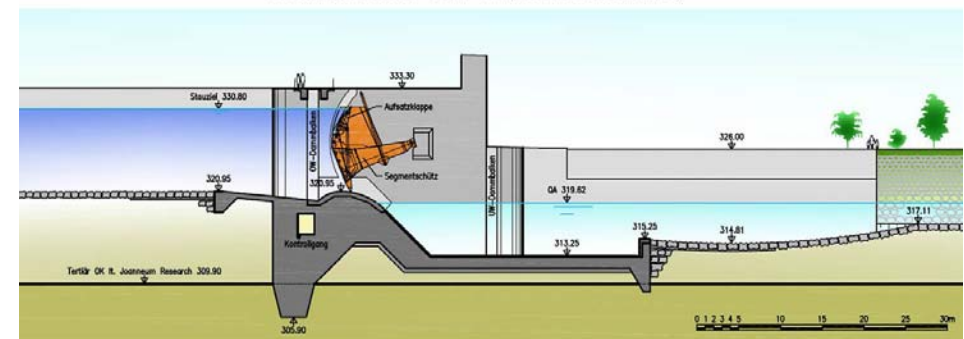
Wehrlängsschnitt Feld A (Ansicht Krafthaus)
